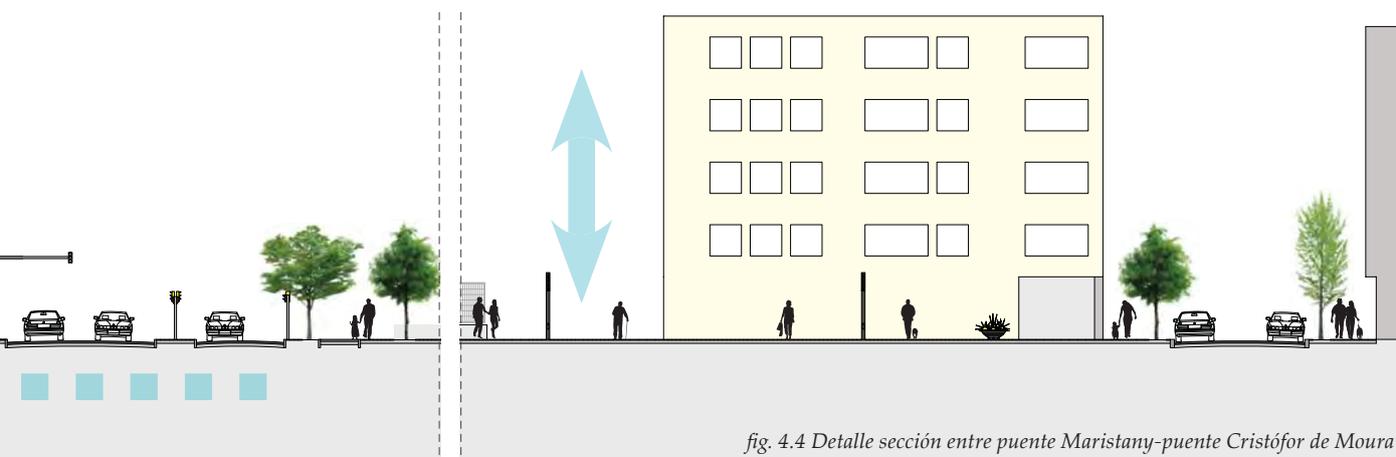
Detalle sección entre puente Maristany- puente Cristófor de Moura
